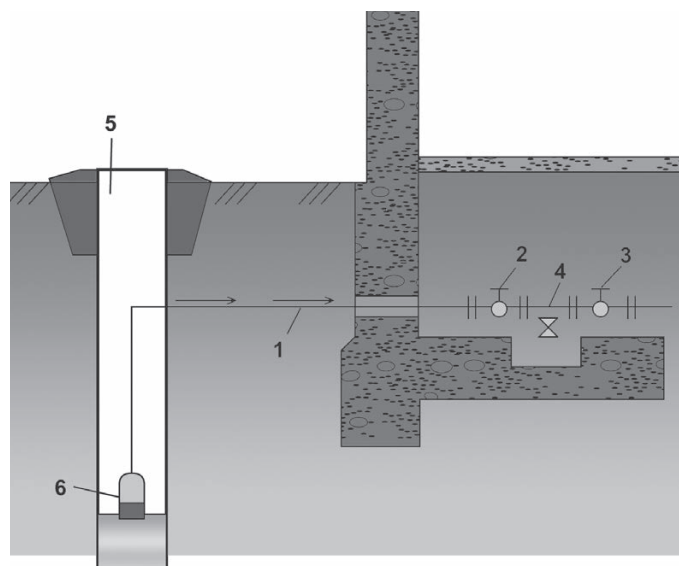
Прокладка трубы в дом через стену фундамента: 1 — ввод, диаметр трубы не менее 5 см; 2 — первый вентиль; 3 — второй вентиль; 4 — спускной кран; 5 — колодец; 6 — насос
